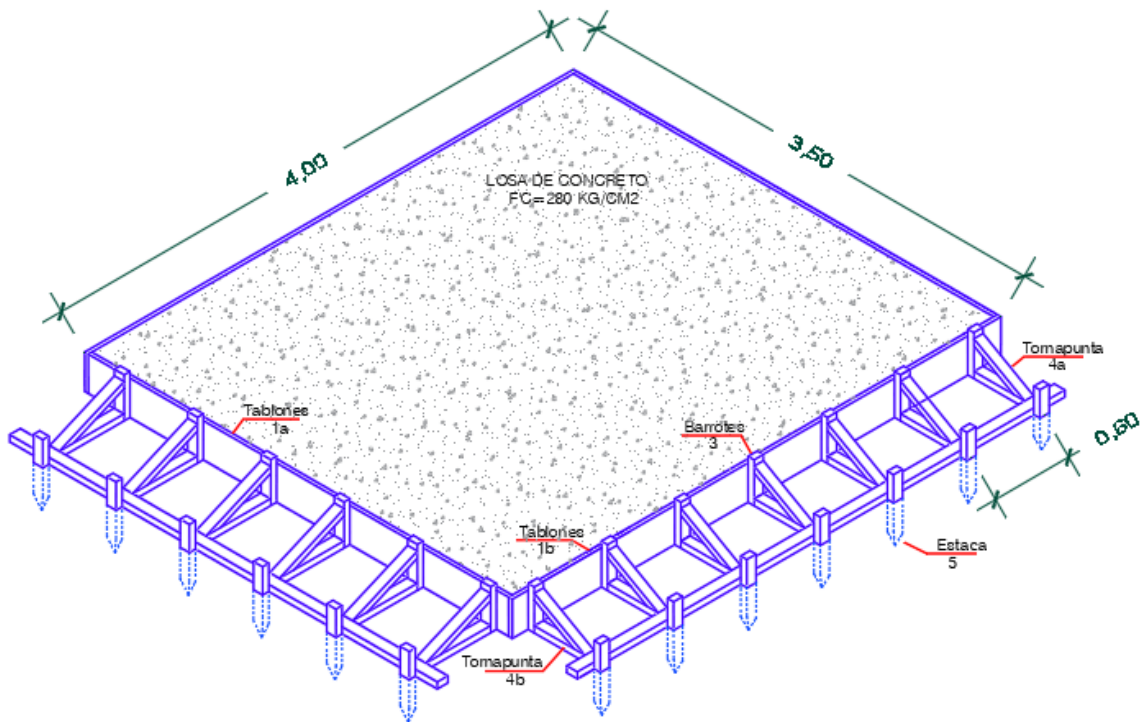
Isométrico de encofrado de pavimento rígido.
